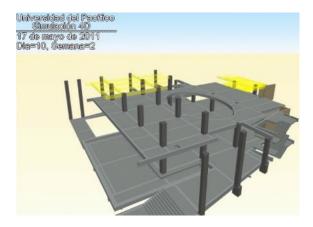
Simulación BIM-4D del proceso constructivo de la estructura del proyecto.
